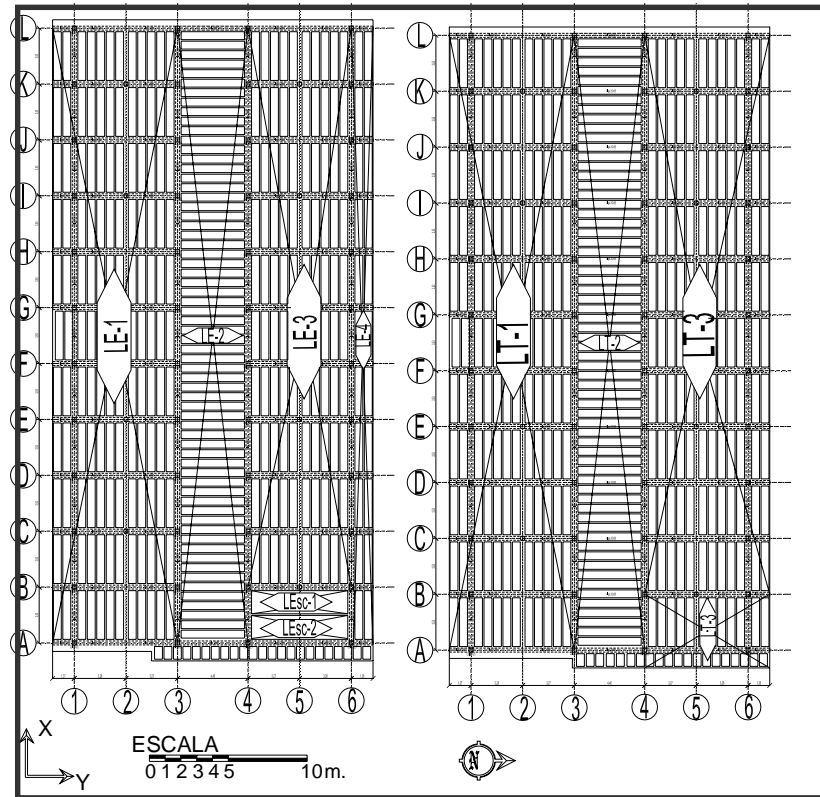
Planos del envigado de las plantas de entrepiso y alta de la U.E. Dr. Lisandro Lecuna.
